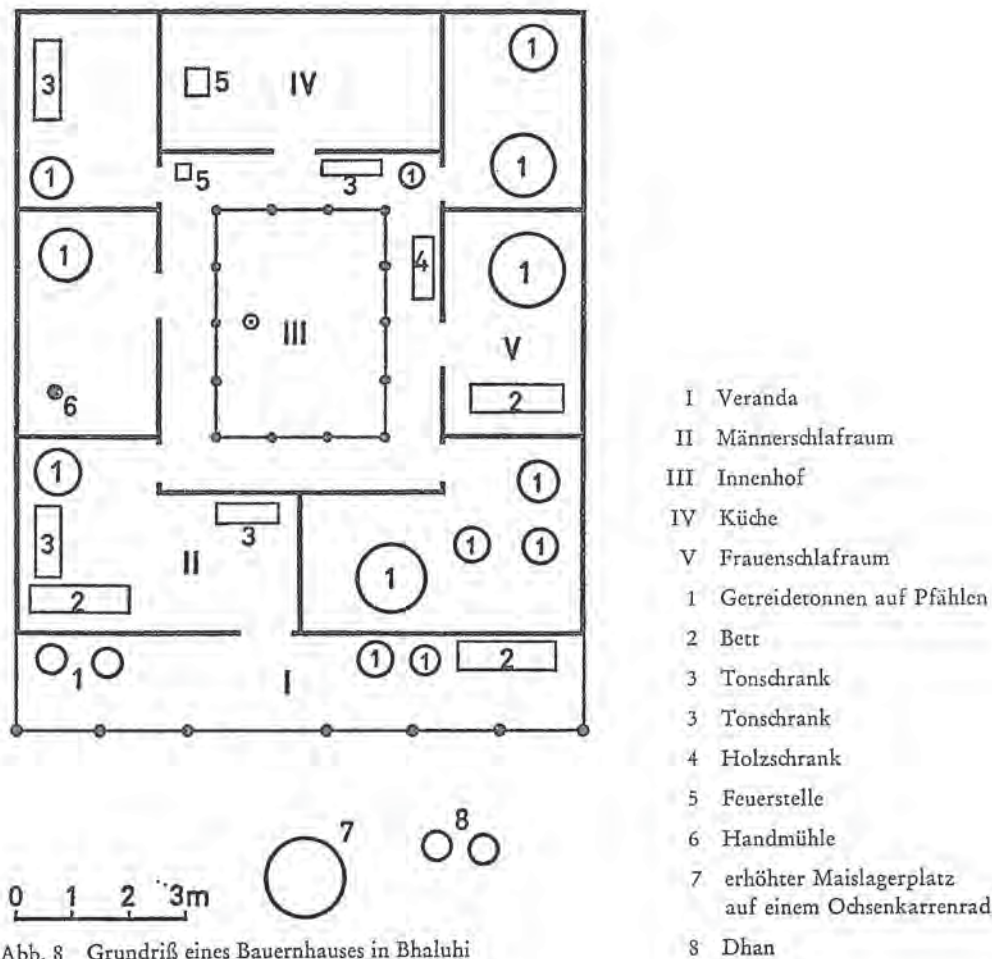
Grundriß eines Bauernhauses in Bhaluhi
